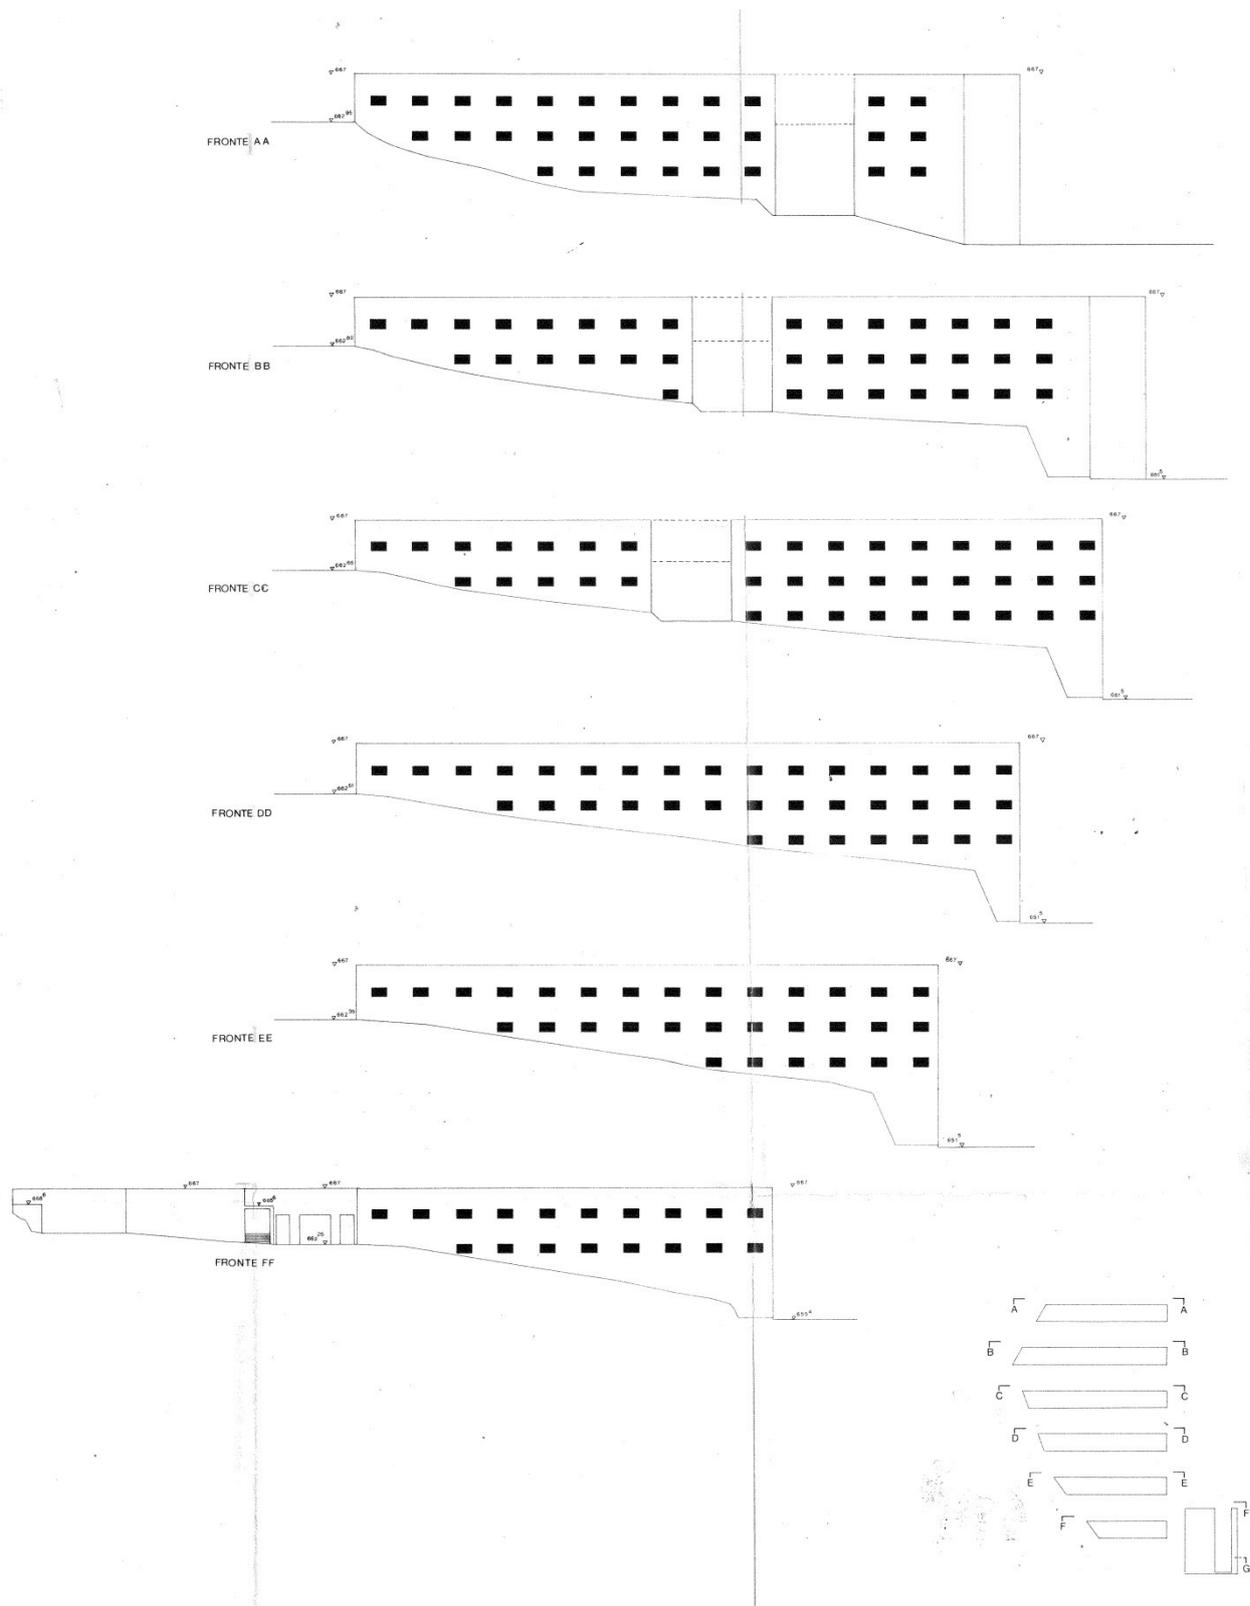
Piano di Recupero di Teora: progetto del quartiere Pianistrello (prospetti).
